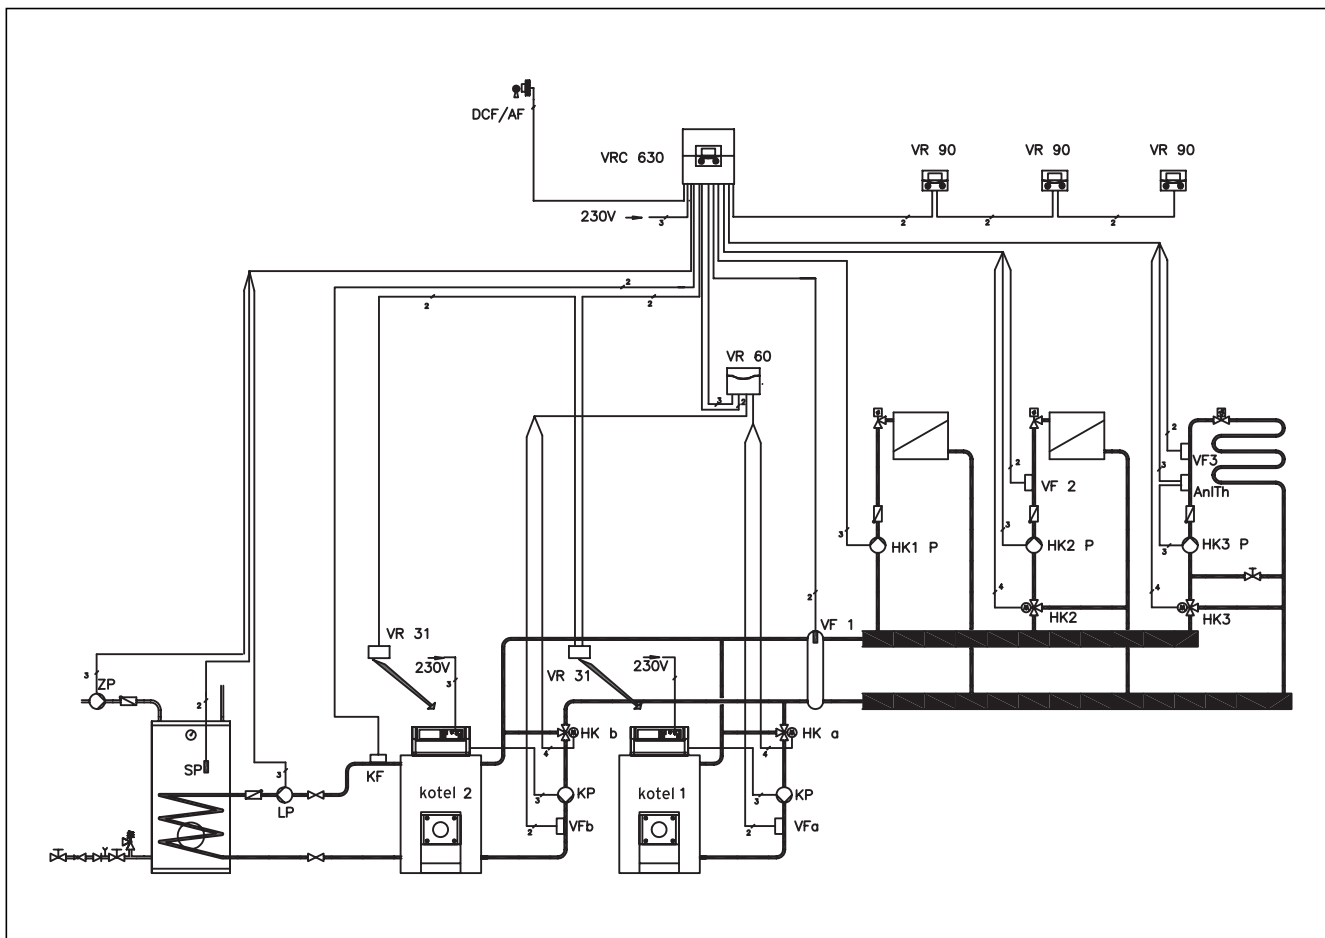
Zapojení VRC 630, GP210, RLA
